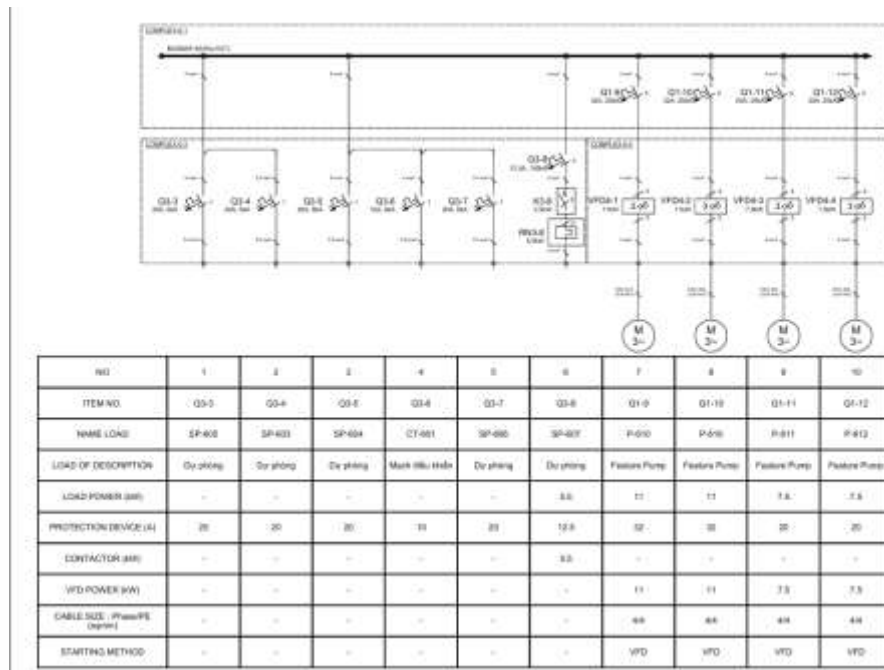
Bản vẽ layout bố trí và lắp đặt tủ MCC Complex 6-1
